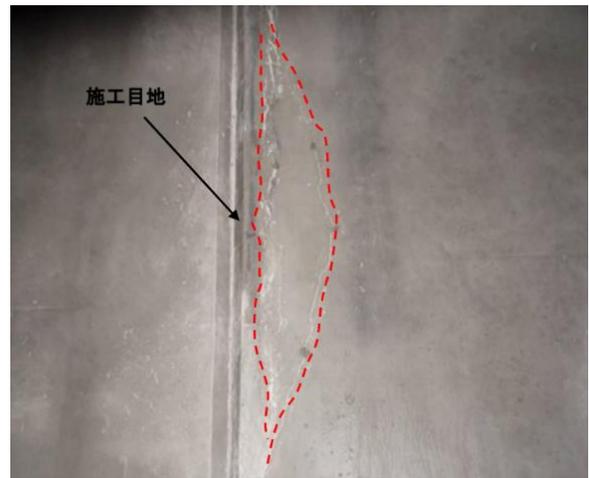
施工目地部のブロック化したひび割れ
